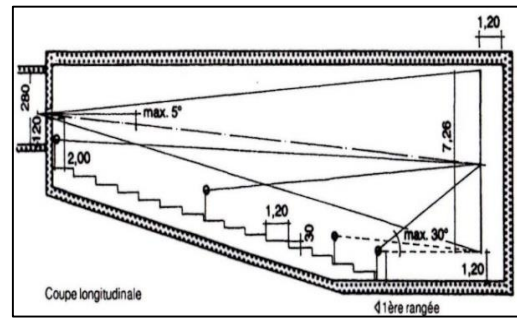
Coupe longitudinale d'une salle de cinéma - source : Neufert 10eme édition
